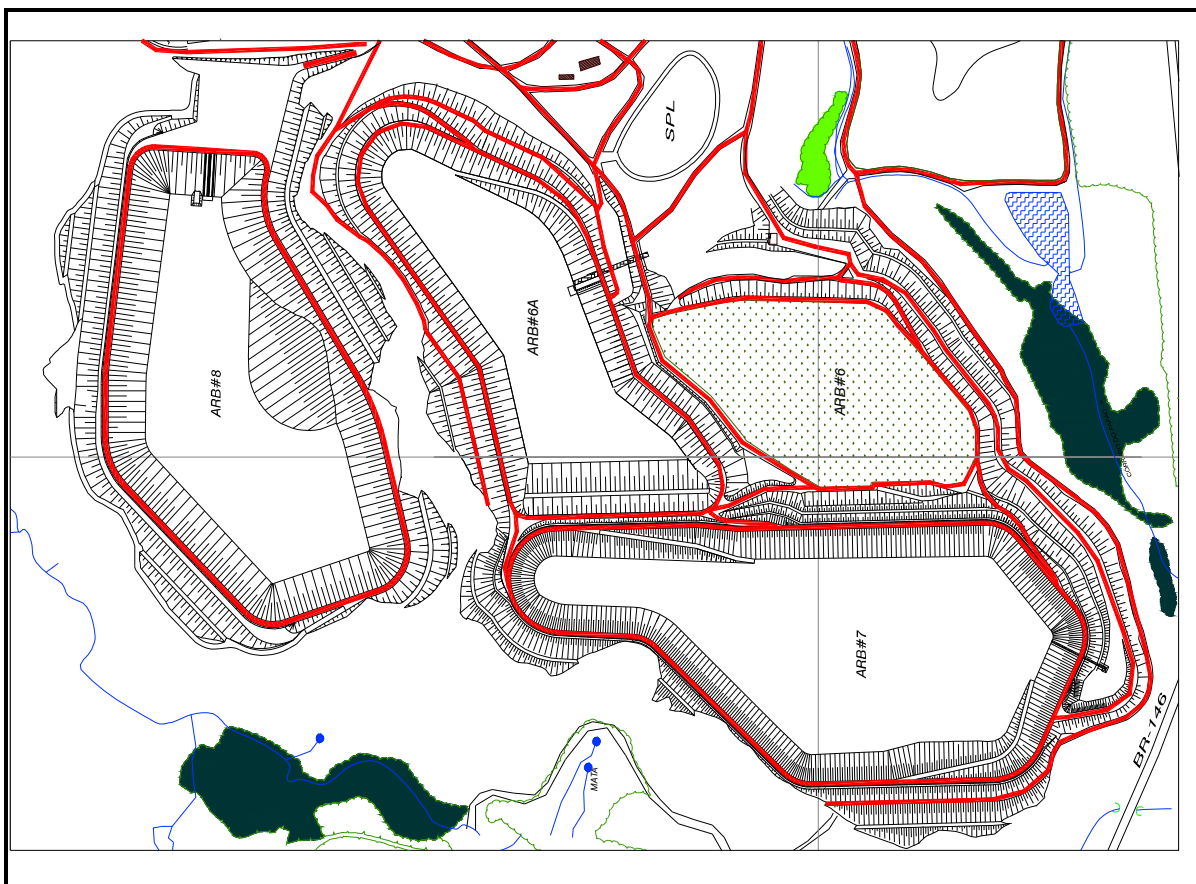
Planta de situação do arranjo de lagos (LPS, 2005c).
